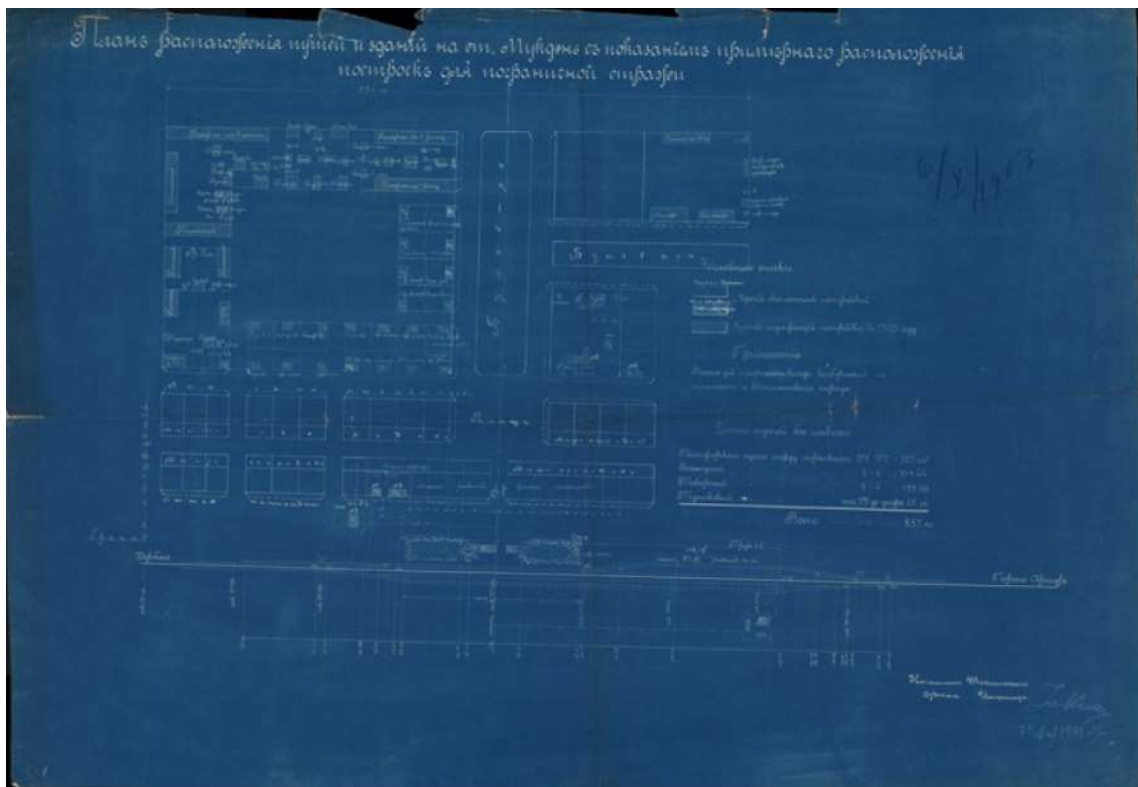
План расположения путей и зданий на станции Мукден
